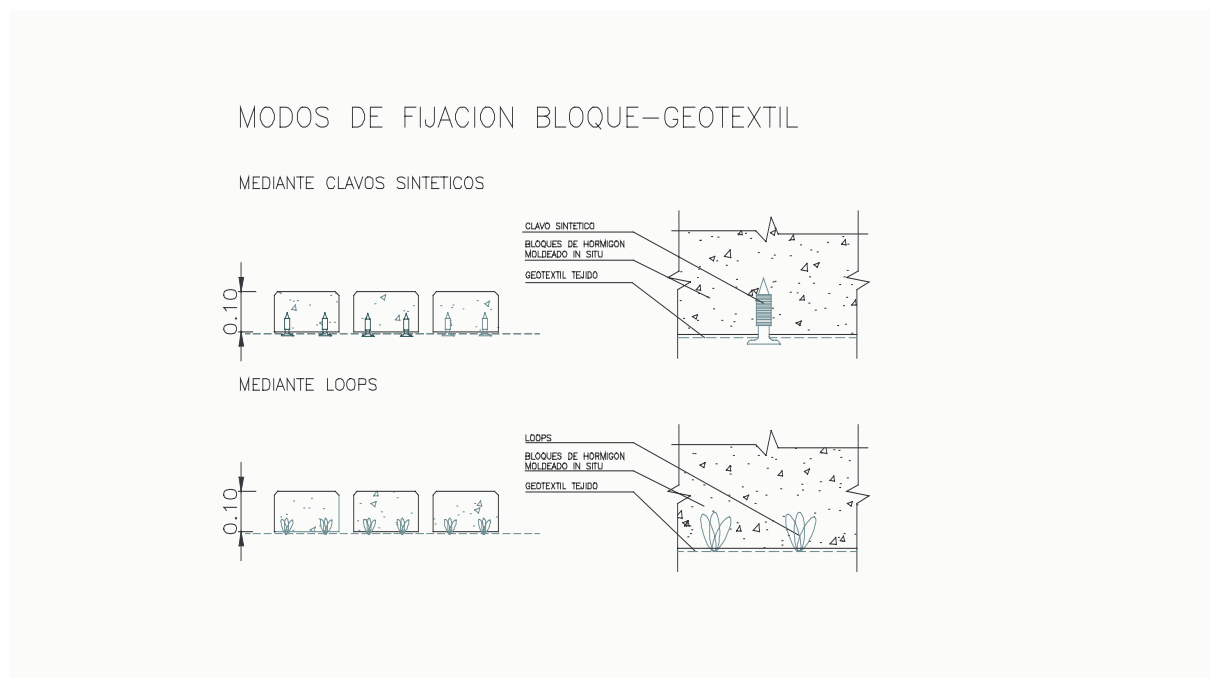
Esquema del método de fijación de los bloques de hormigón al geotextil.
